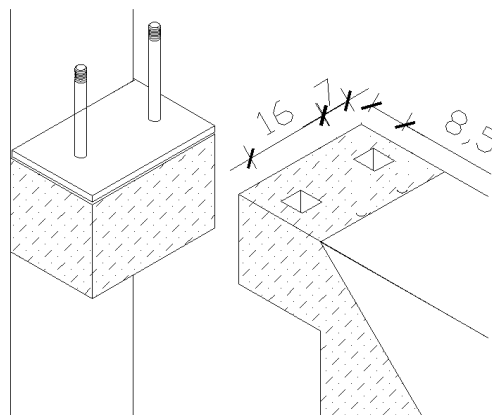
Detalhe da geometria da ligação ensaiada (medidas em cm)
